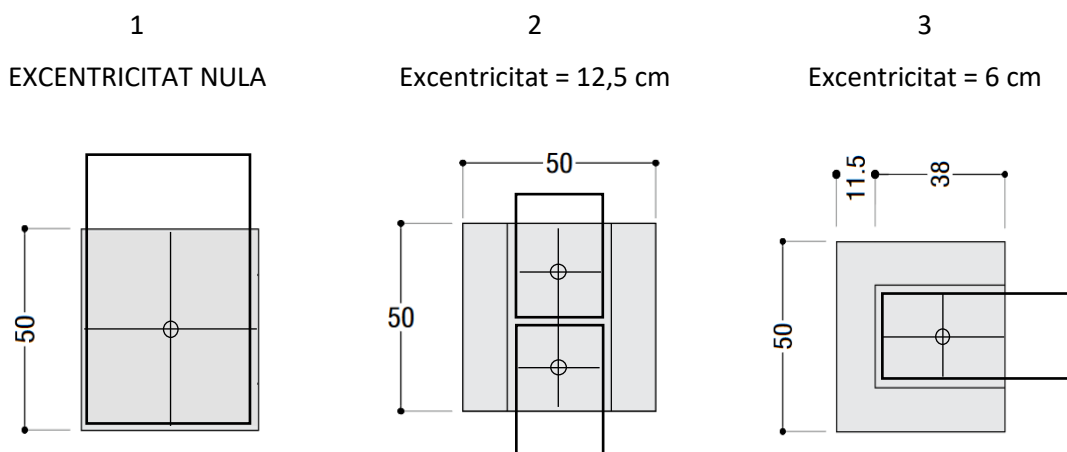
Detalls constructius unió jàssera – pilar. Font: Elaboració Pròpia
